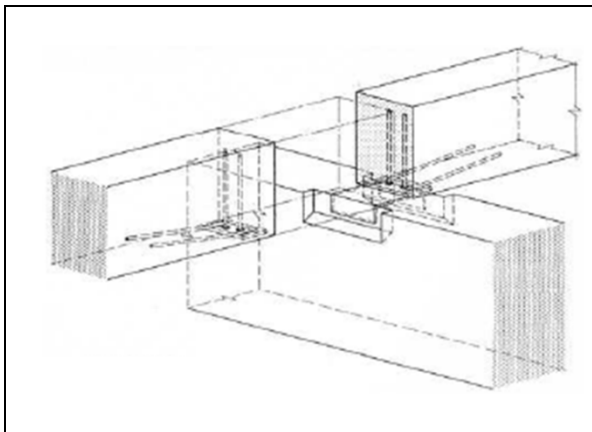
Ligação por chapas soldadas (Stupré,
